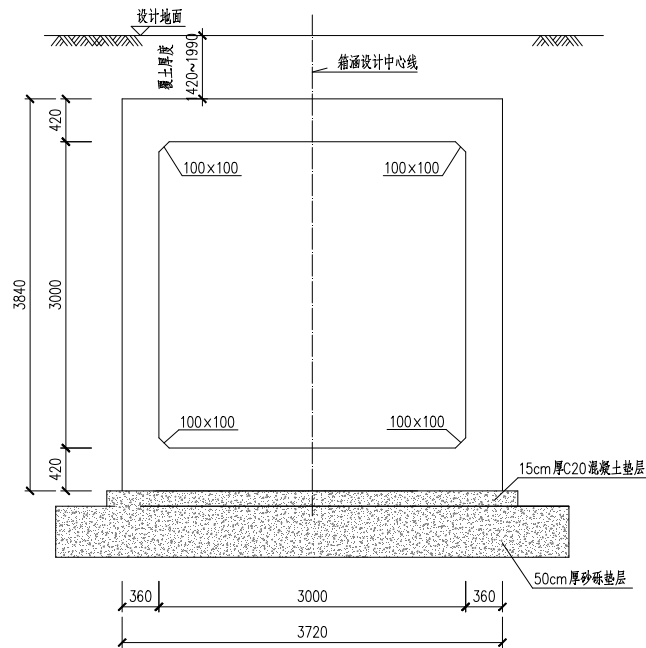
K4+453.3 箱涵横断面图（单位：mm）
